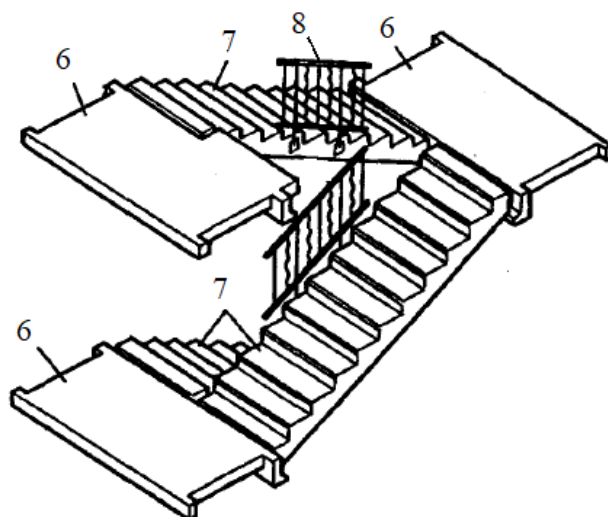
Конструктивные элементы сборных железобетонных лестниц:
